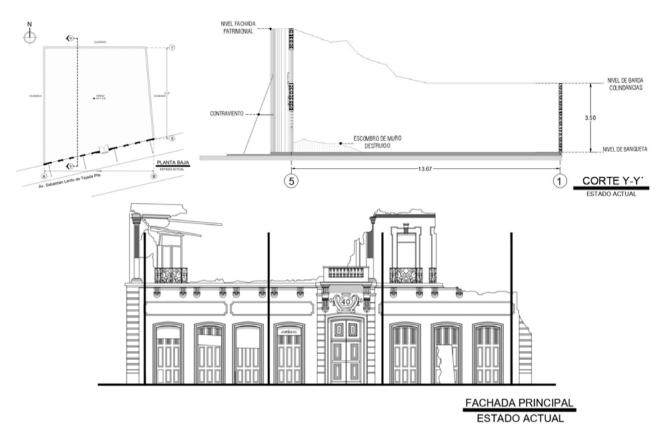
Estado actual del inmueble patrimonial, planta, corte y fachada Fuente: elaboración propia, (2022).
